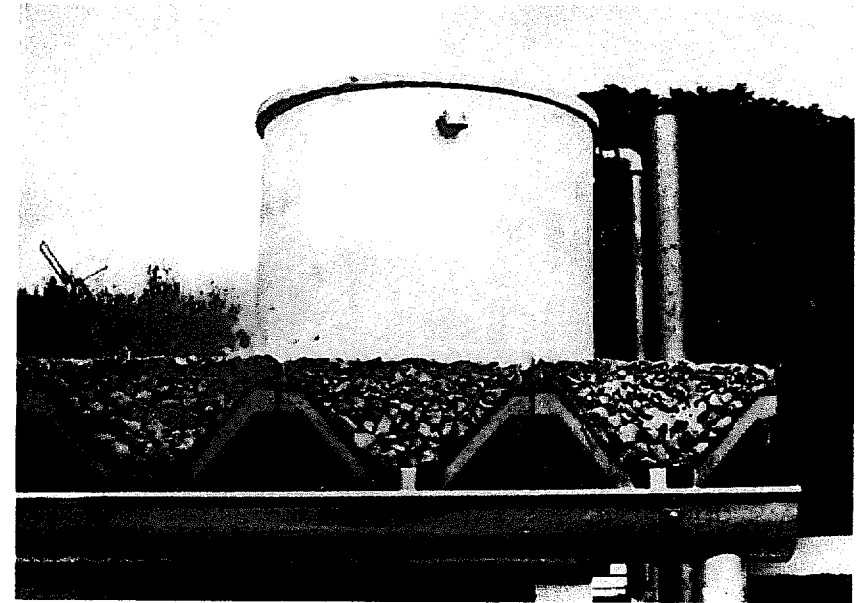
Detail der vorfabrizierten trogförmigen Betonelemente mit Einkornbeton-Randabschlußblöcken
